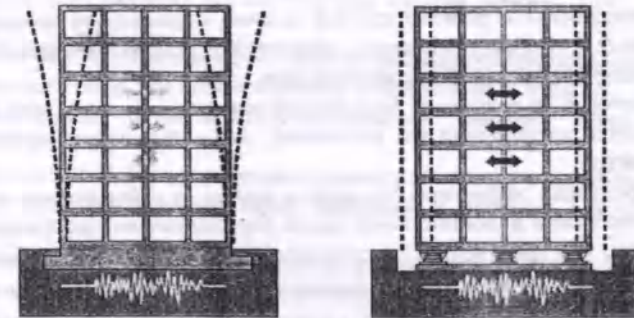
Поведение здания без и с ТРМЭ при сейсмическом колебании
